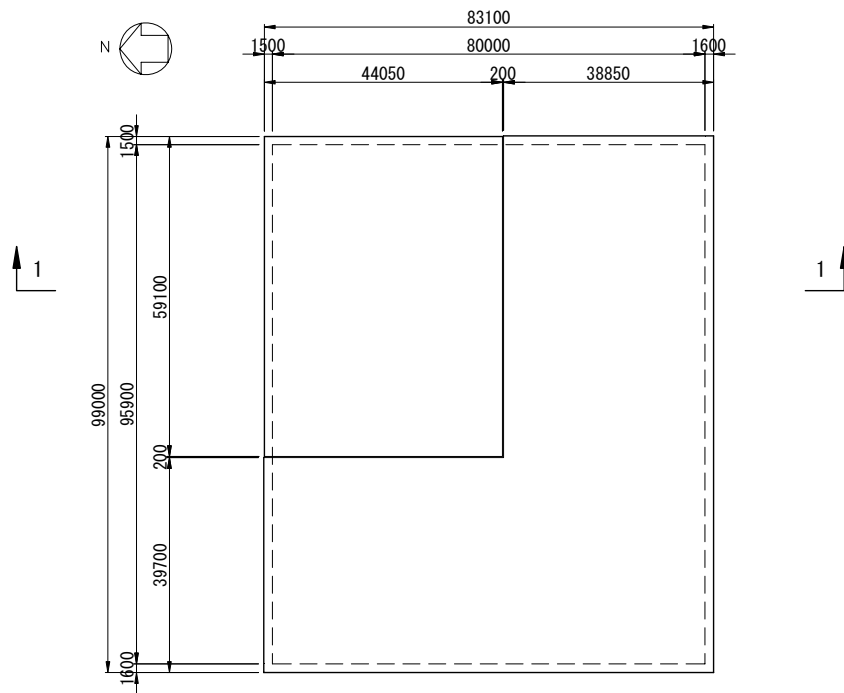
地盤改良平面図 (単位 : mm)
